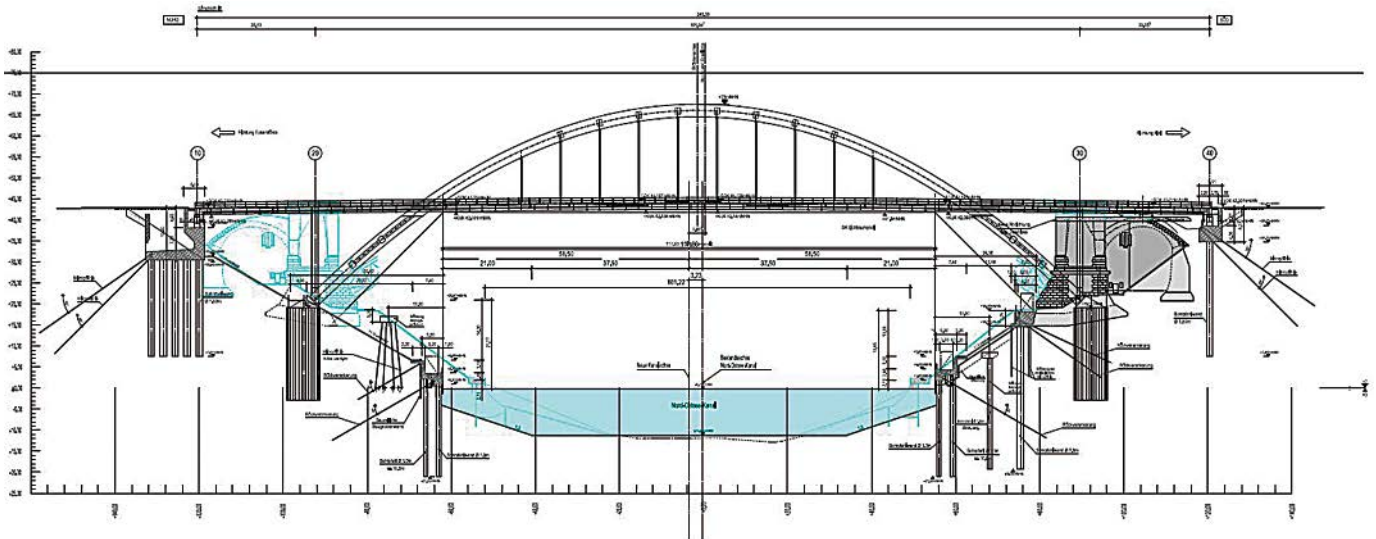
Längsschnitt Brückenbau; Bestand über Wasser blau hinterlegt (Planung WKC-Anwika)
